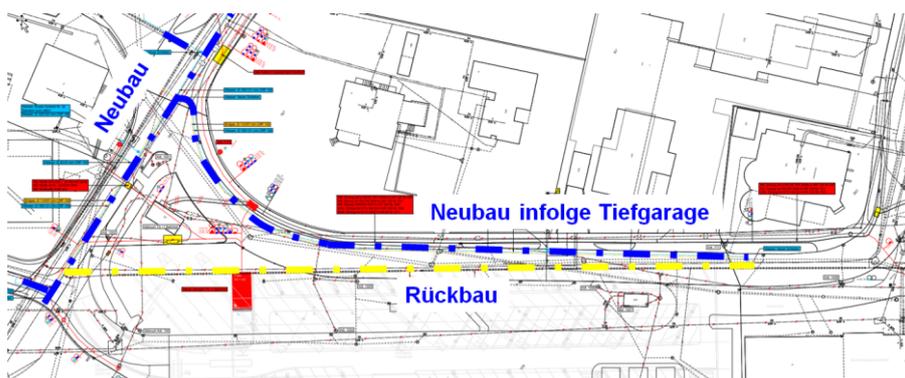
Planausschnitt mit dargestelltem Erneuerungsbedarf WA
